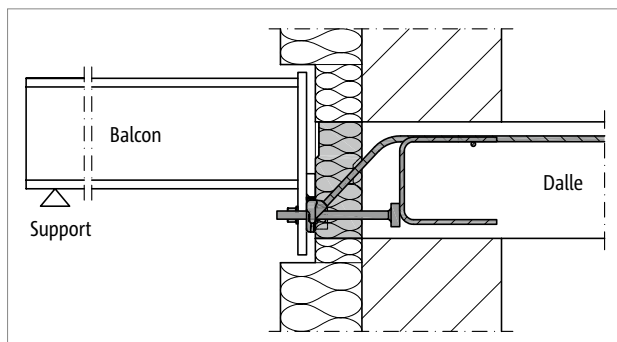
Schöck Isokorb® T type SQ : Transition sans obstacle grâce au décalage en hauteur
